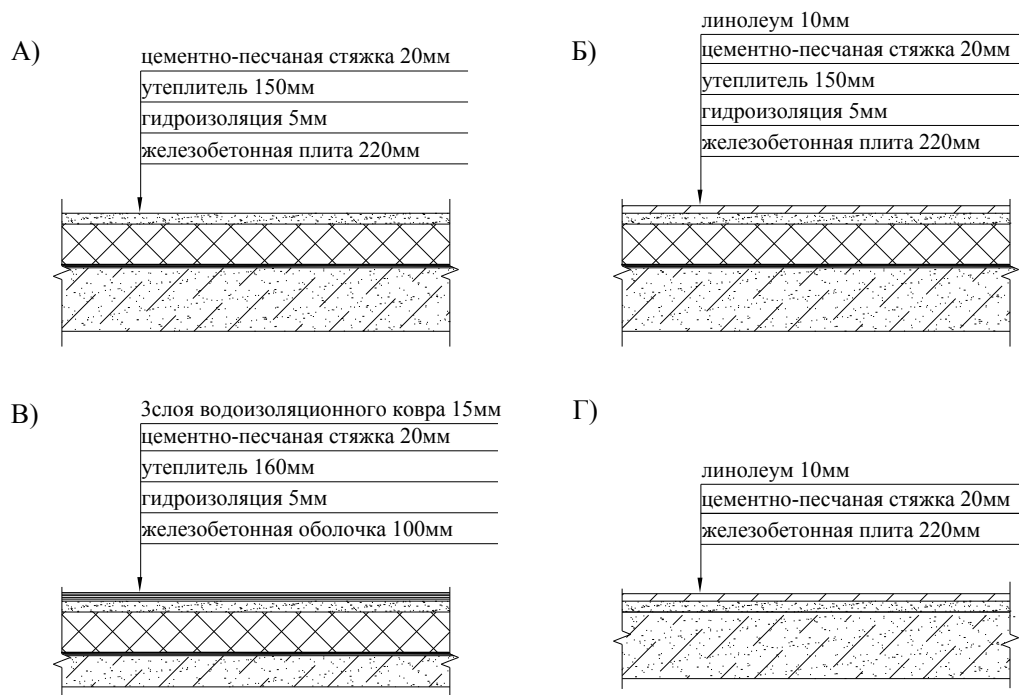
А) чердачное перекрытие; Б) цокольное перекрытие; В) покрытие над спортивным залом; Г) междуэтажное перекрытие
